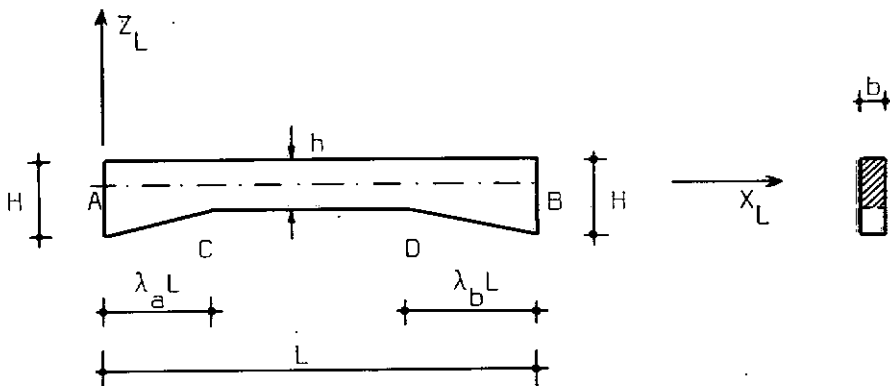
Viga de eixo reto com mÍslas retas verticais
